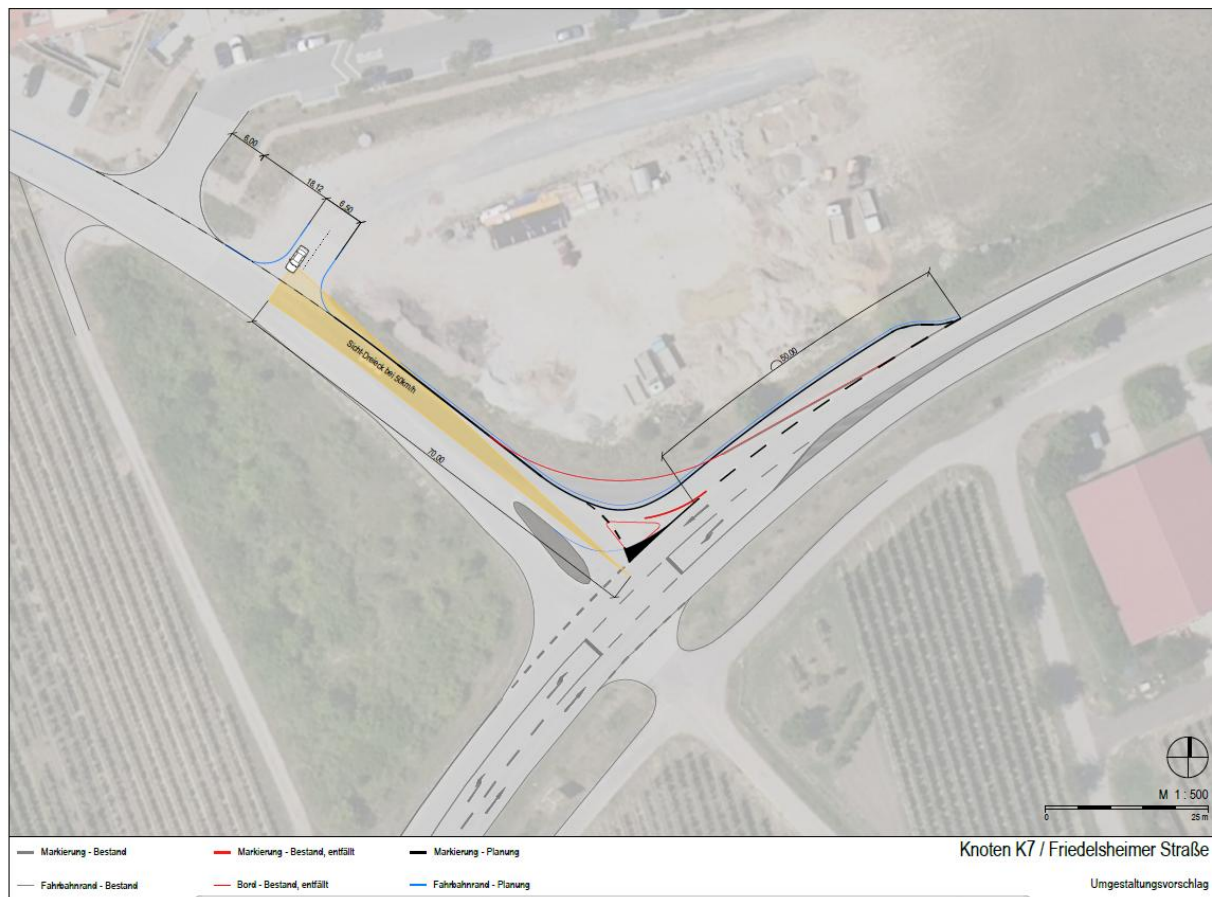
Geplante Abbiegespur K7 / Friedelsheimer Straße; Planung Fachbüro R+T Darmstadt, Stand: 15.08.2024.
